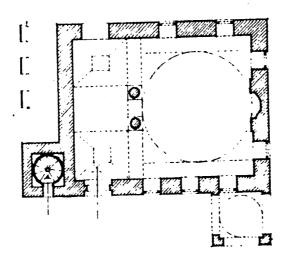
مسقط أفقي لجامع بايزيد يلدريم في مودورنو . (عن : Kuran) .
